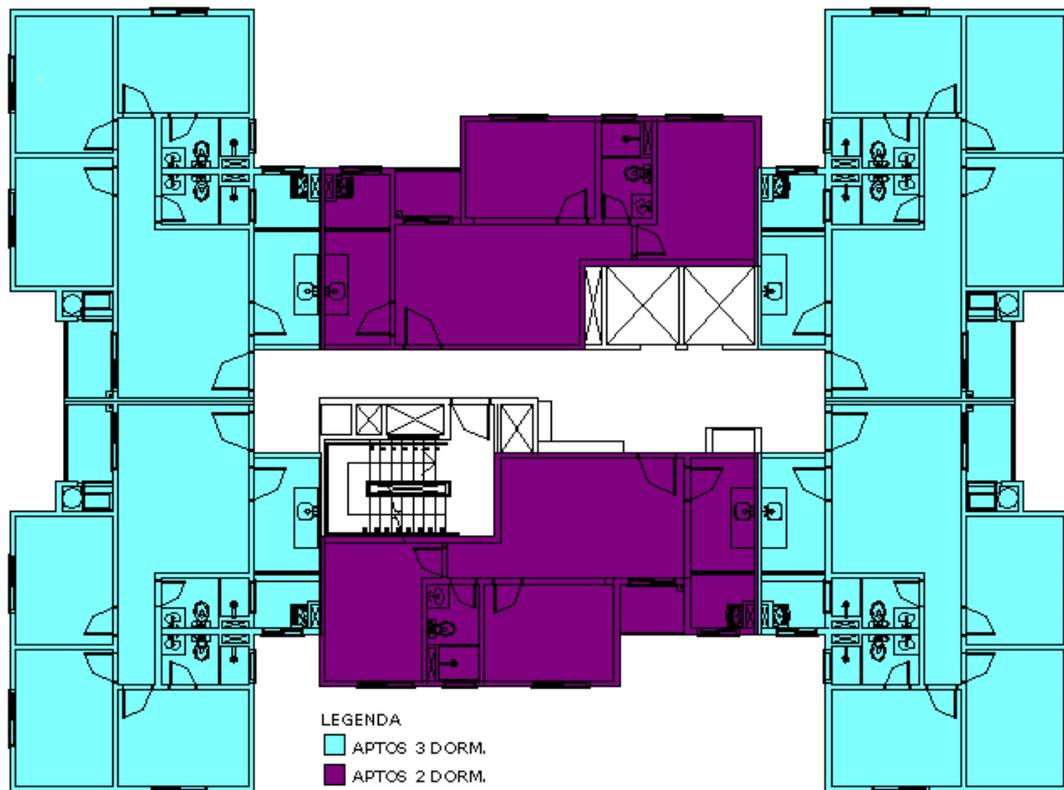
planta baixa do pavimento tipo (trabalho não publicado)¹
